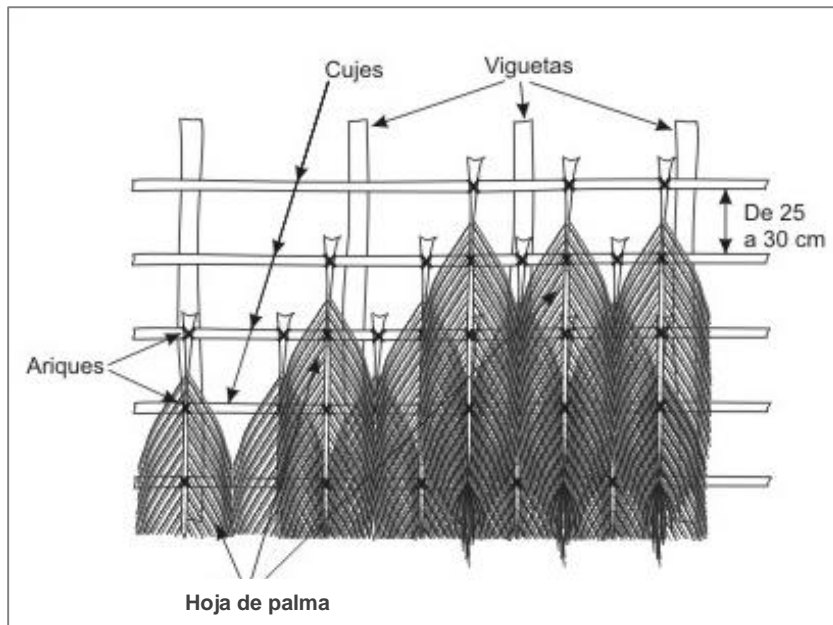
Detalle constructivo de la técnica de hoja de palma en techo con estructura de madera. Fuente: ecohabitar.org
